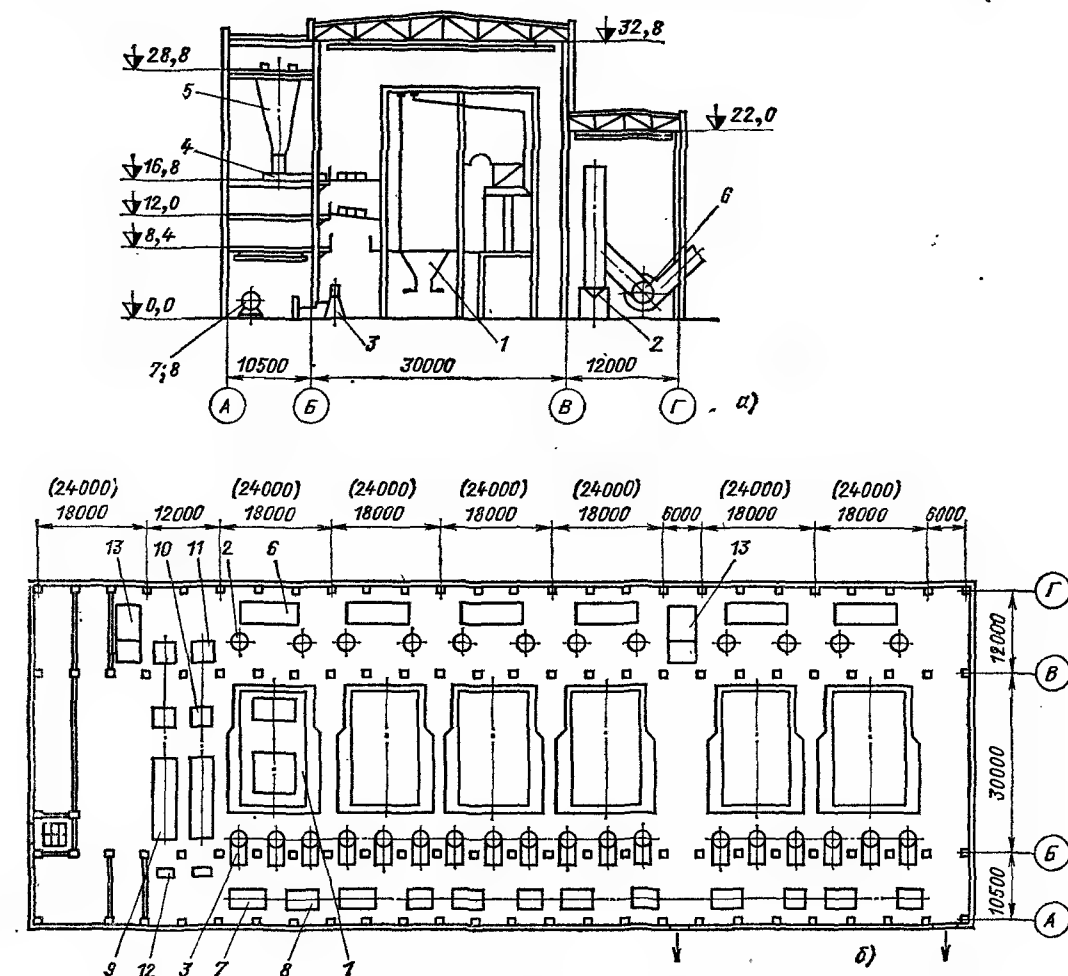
Унифицированный главный корпус котельной на твердом топливе с водогрейными котлами КВ-ТК-100 и паровыми котлами КЕ-25-14С.
